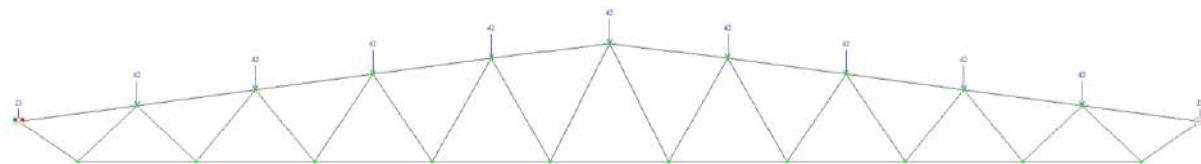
Розрахункова схема ферми у ПК ЛИРА САПР
